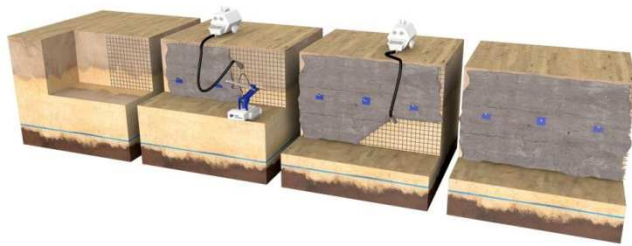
ILLUSTRATIONS DE PAROIS CLOUEES ([HTTP://WWW.ATLAS-FONDATIONS.FR](http://www.atlas-fondations.fr))
